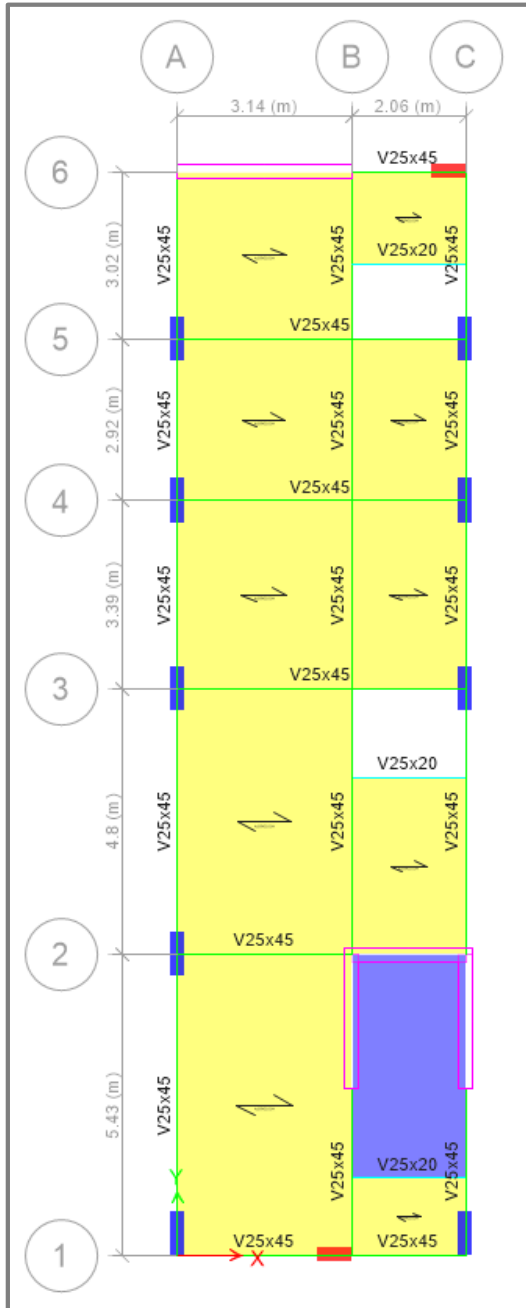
Modelo vista en planta del edificio de 5 pisos con la estructura rigidizado en dirección XX e YY
